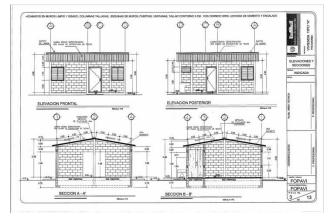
Plano de elevaciones vivienda tipo Fopavi. Fotografía de http://www.google.com.gt 2015
